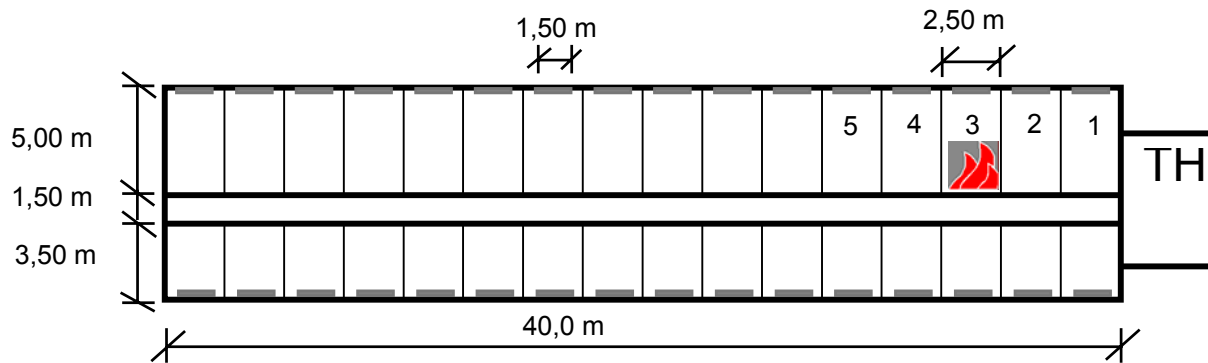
Grundriss der Nutzungseinheit mit Bürozellen
